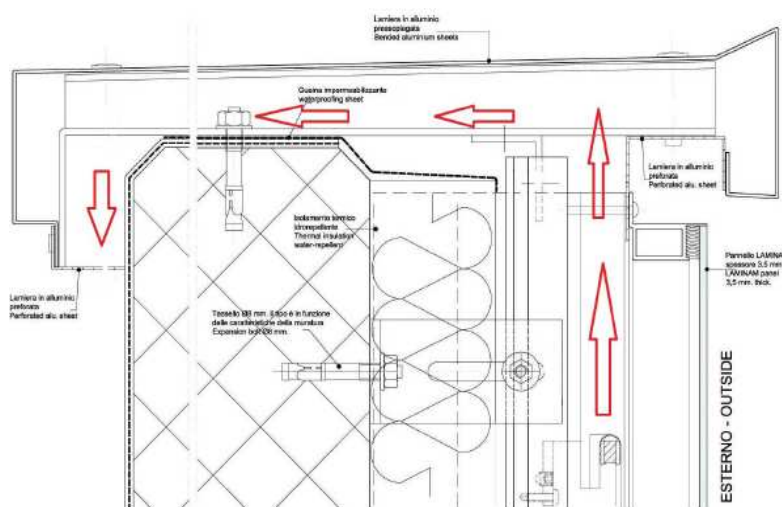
Fachada Laminam - Seção vertical: fechamento superior.
